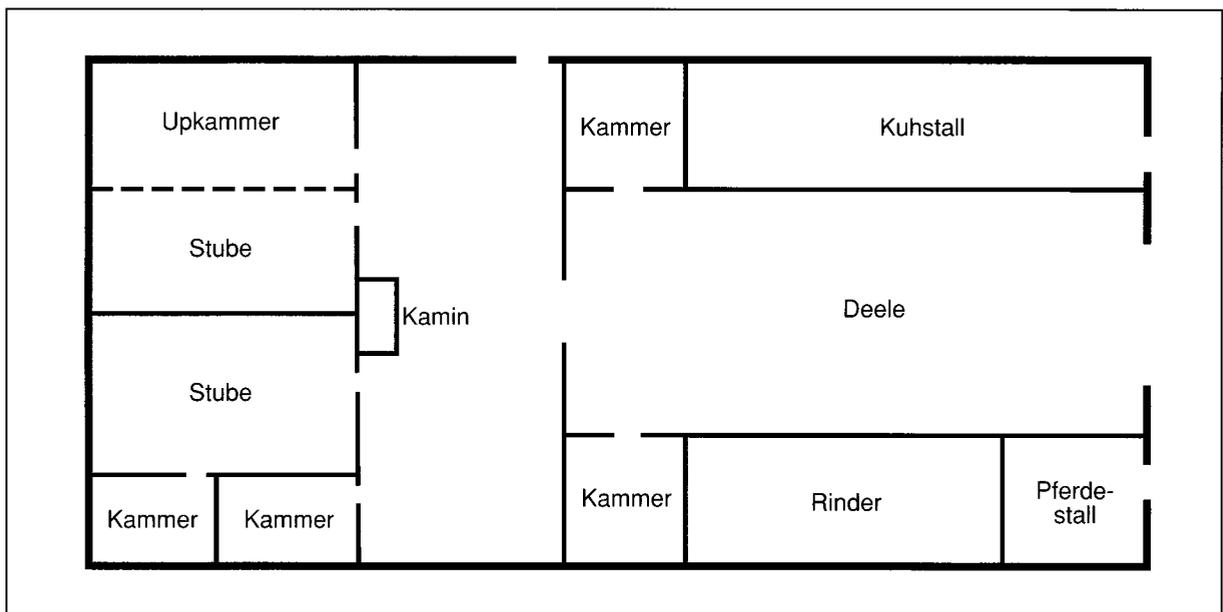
Grundrissplan eines westfälischen Bauernhauses
